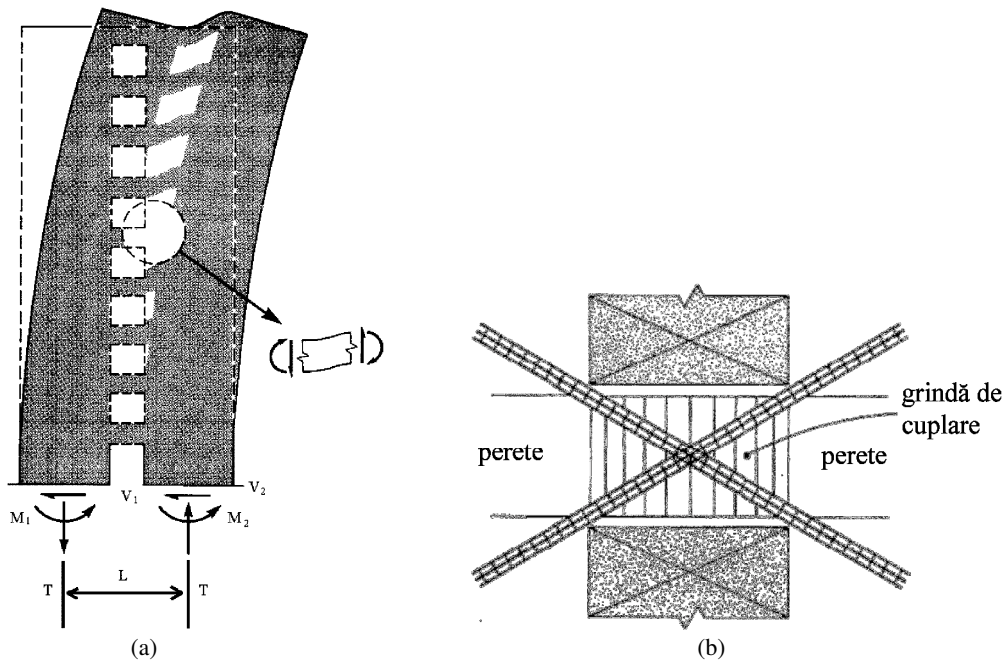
Eforturile dintr-un perete cuplat (a) și armarea diagonală a grinzii de cuplare (b), Derecho și Kianoush, 2001.
